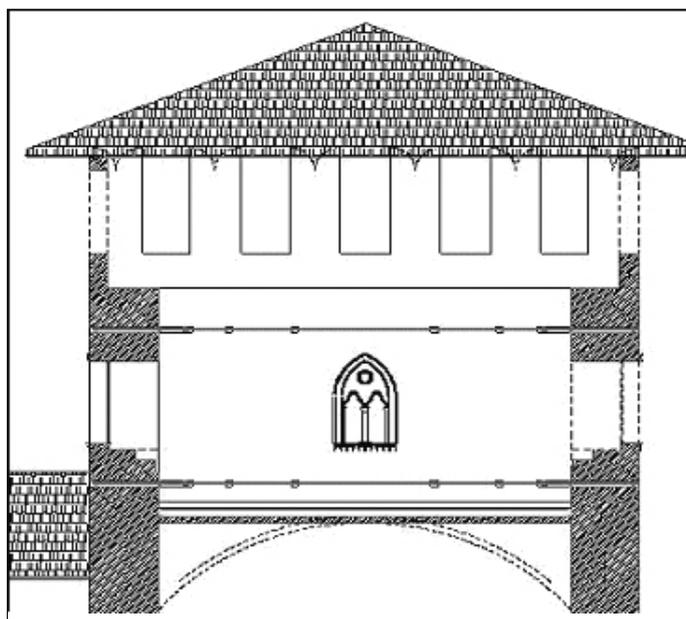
Pavia: castello visconteo. Torre Sud/Est: sezione con indicata la posizione delle tirantature.
